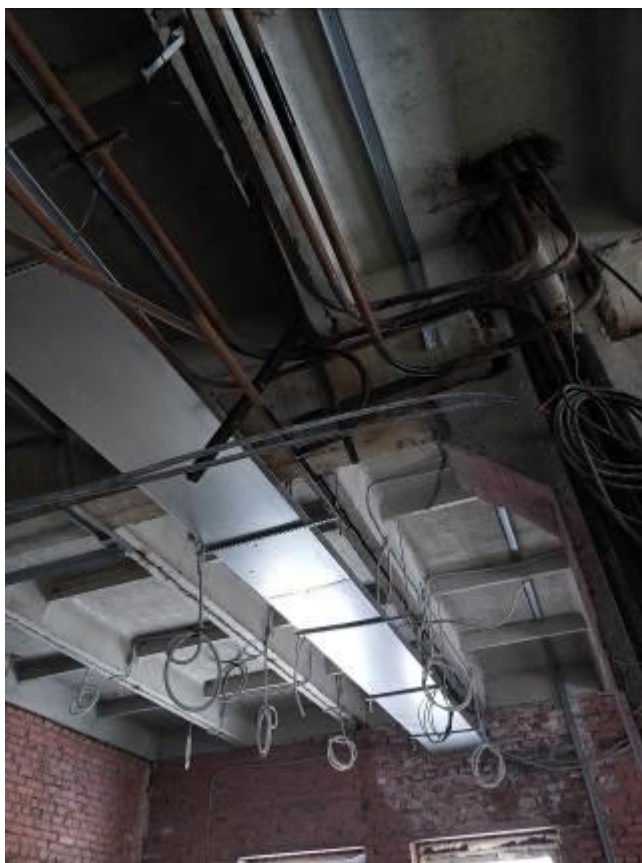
Пристройка ЦИК, 2 этаж, система электроснабжения не смонтирована, отсутствуют опоры закладных трубопроводов для электропроводки, коррозия трубопроводов.
